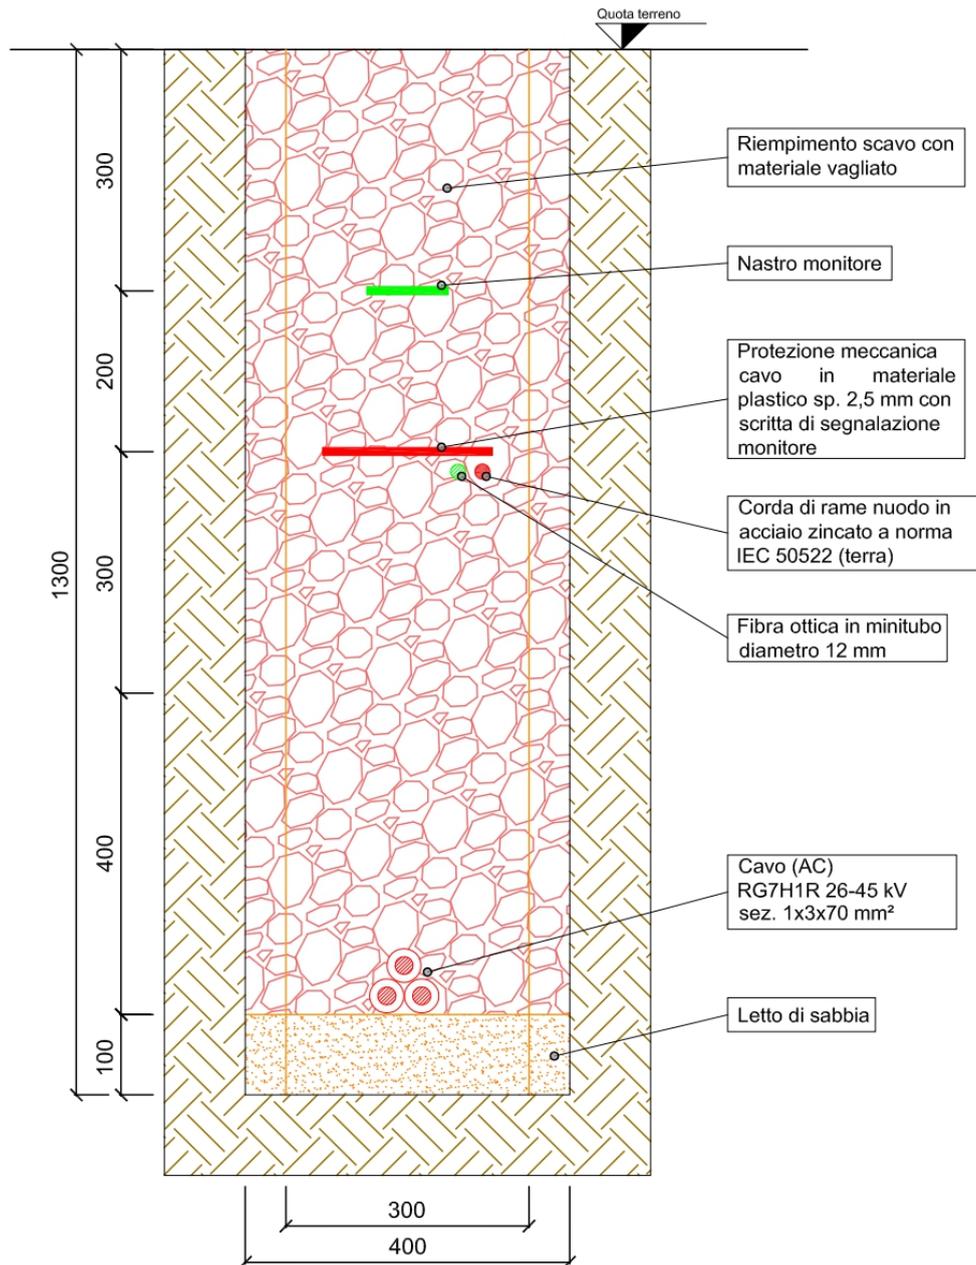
Tipico sezione di posa con un cavidotto interno da 3x70 mm²
